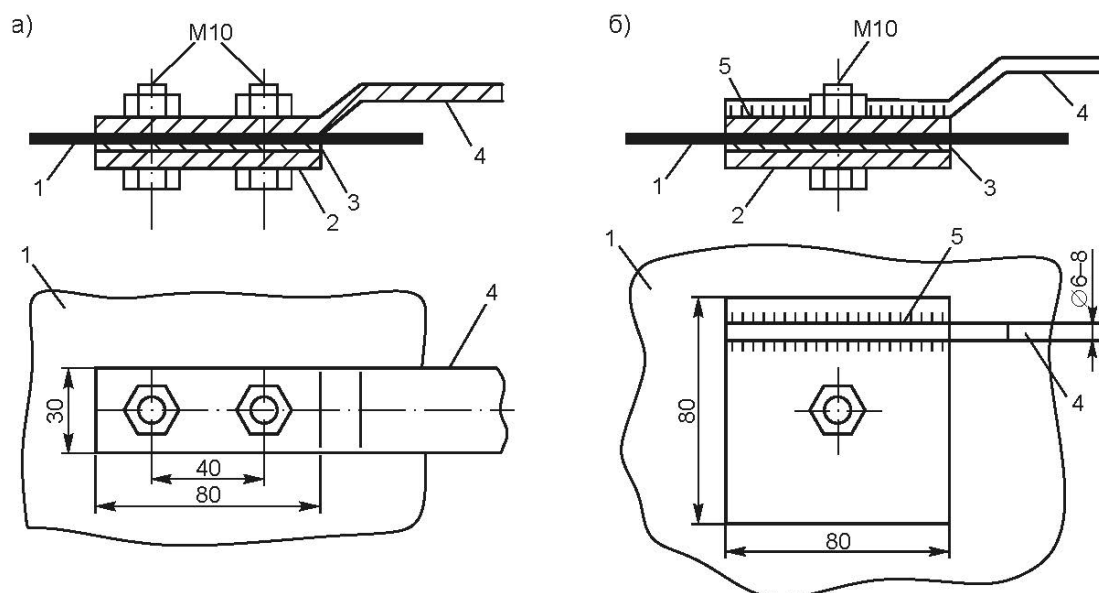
Соединение стального элемента кровли с токоотводом с помощью специальных зажимов:
